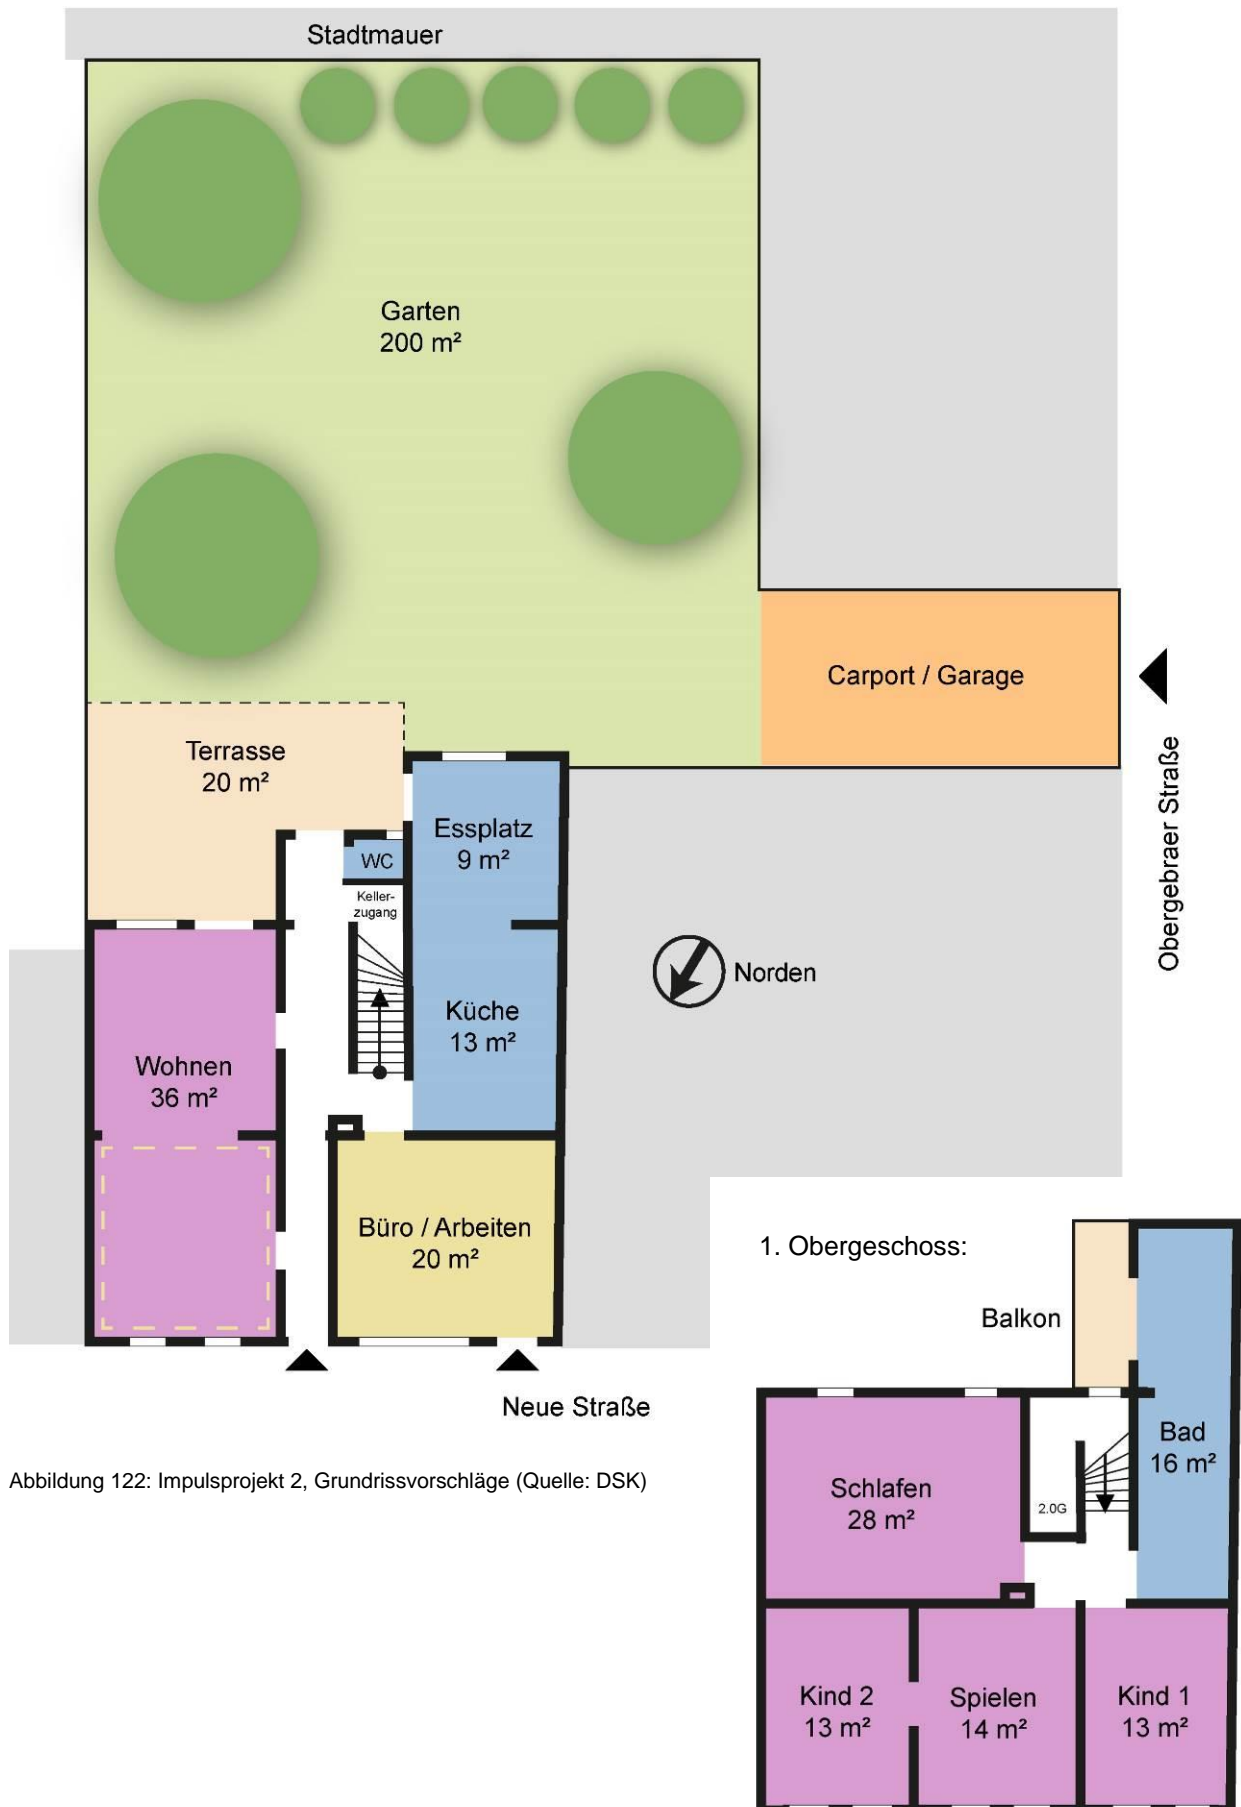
Impulsprojekt 2, Grundrissvorschläge (Quelle: DSK)
